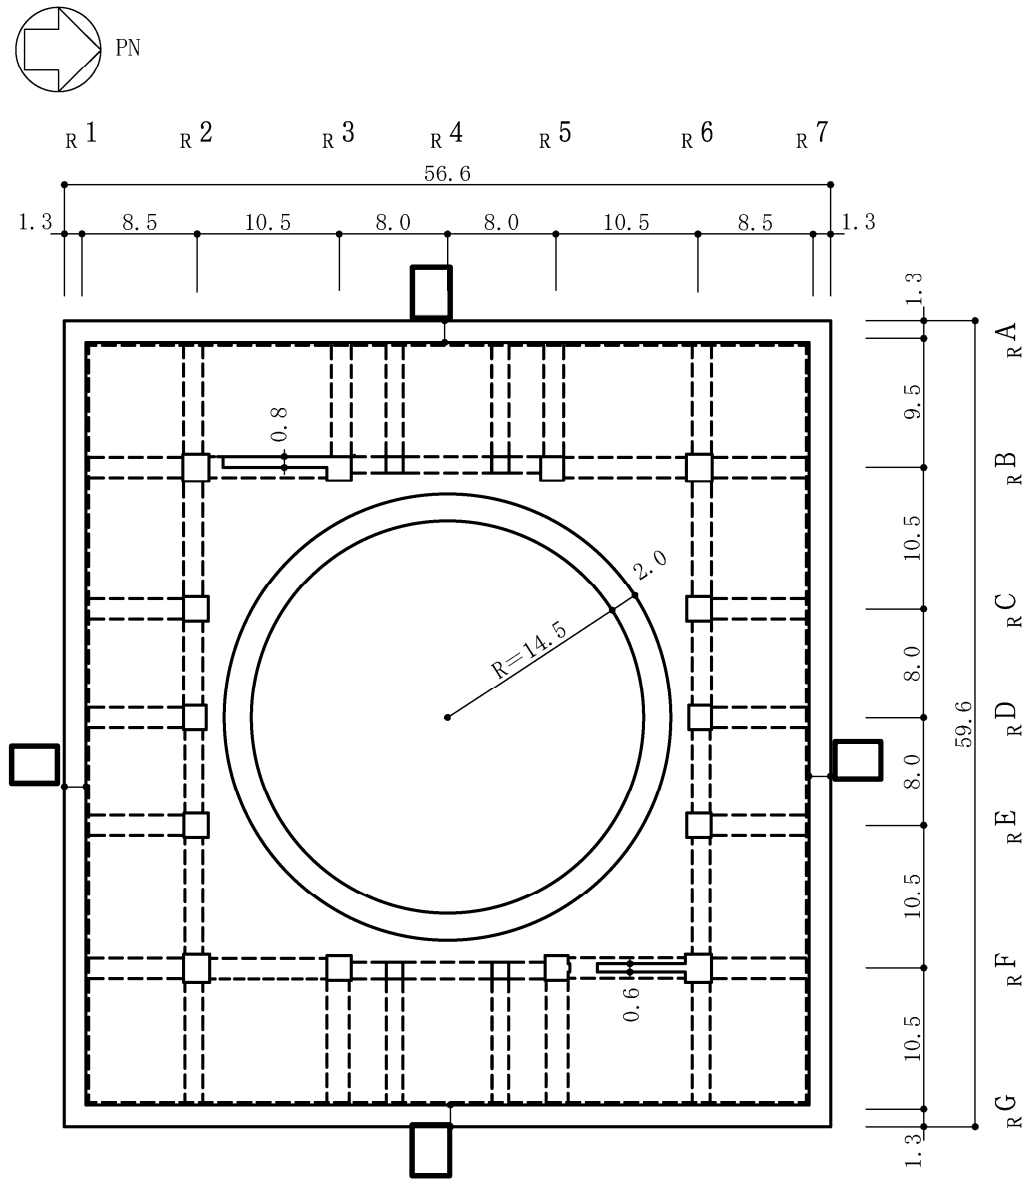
原子炉建屋の概略平面図 (B2F, T. M. S. L. -1.7m) (2/9) (単位 : m)
